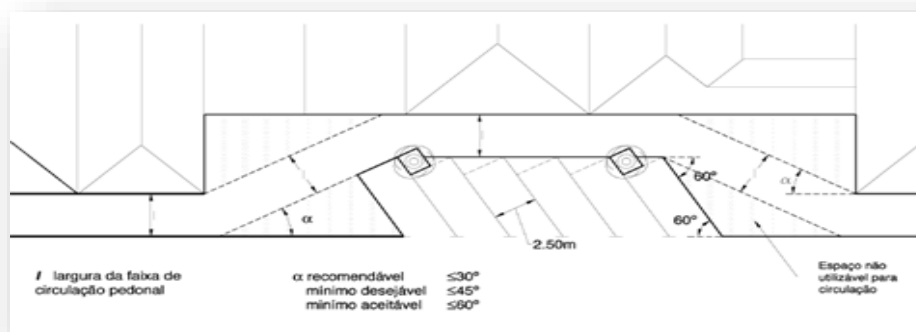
Pormenor de transição entre perfis transversais com estacionamento em espinha
